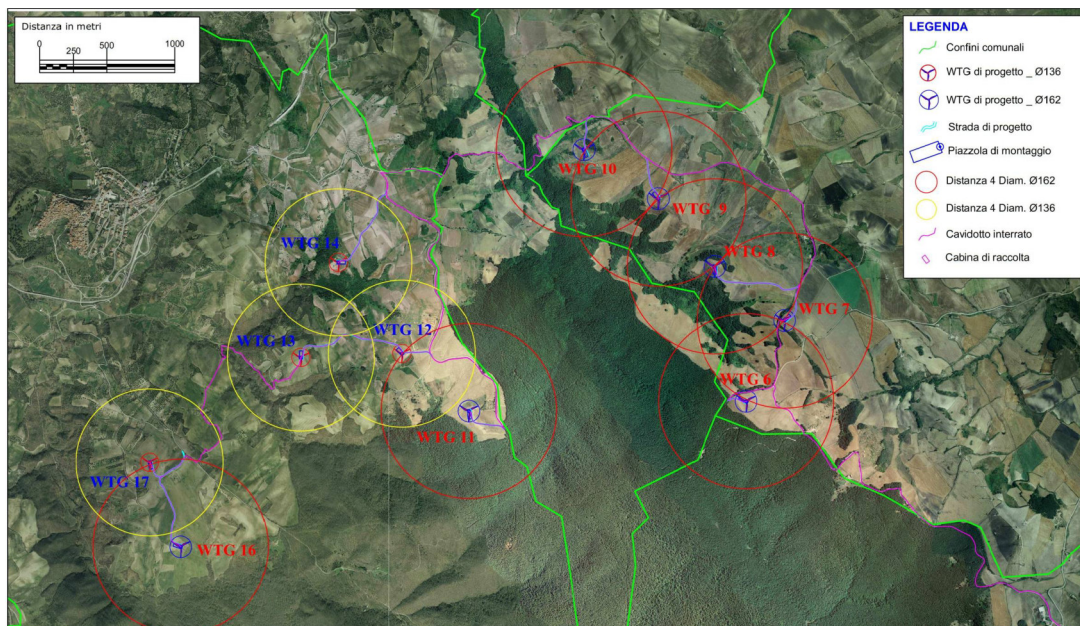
\_Zona C e B del progetto con verifica delle distanze minime
